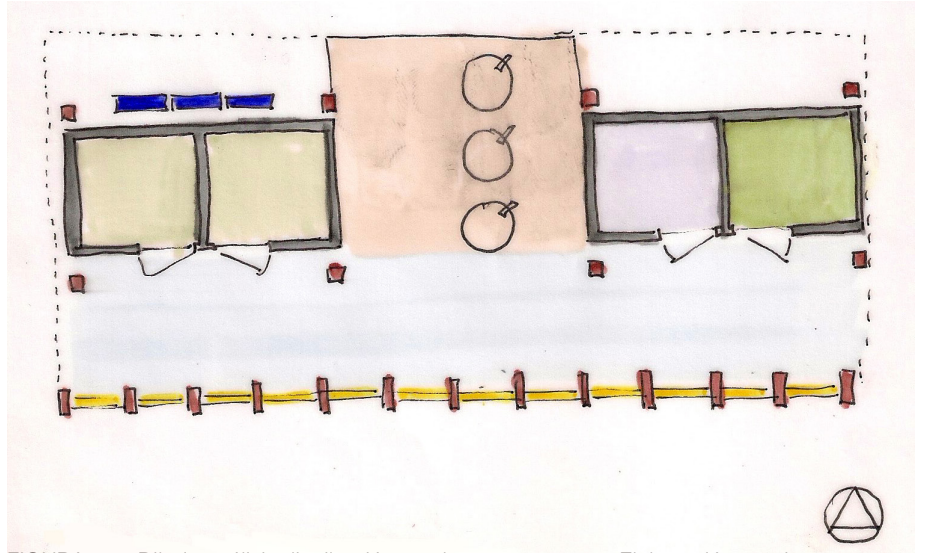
Dibujo análisis distribución en planta y estructura. Elaboración propia
